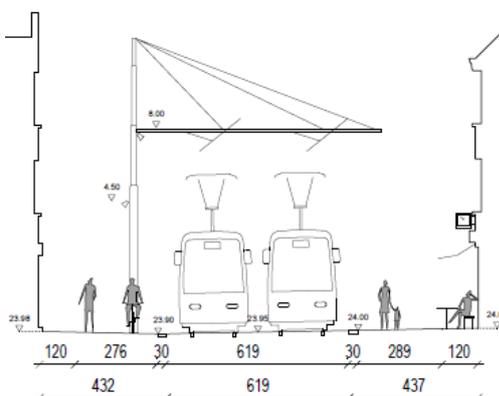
Coupe au niveau de la chaussée de Bruxelles (A-Practice, 2021)
